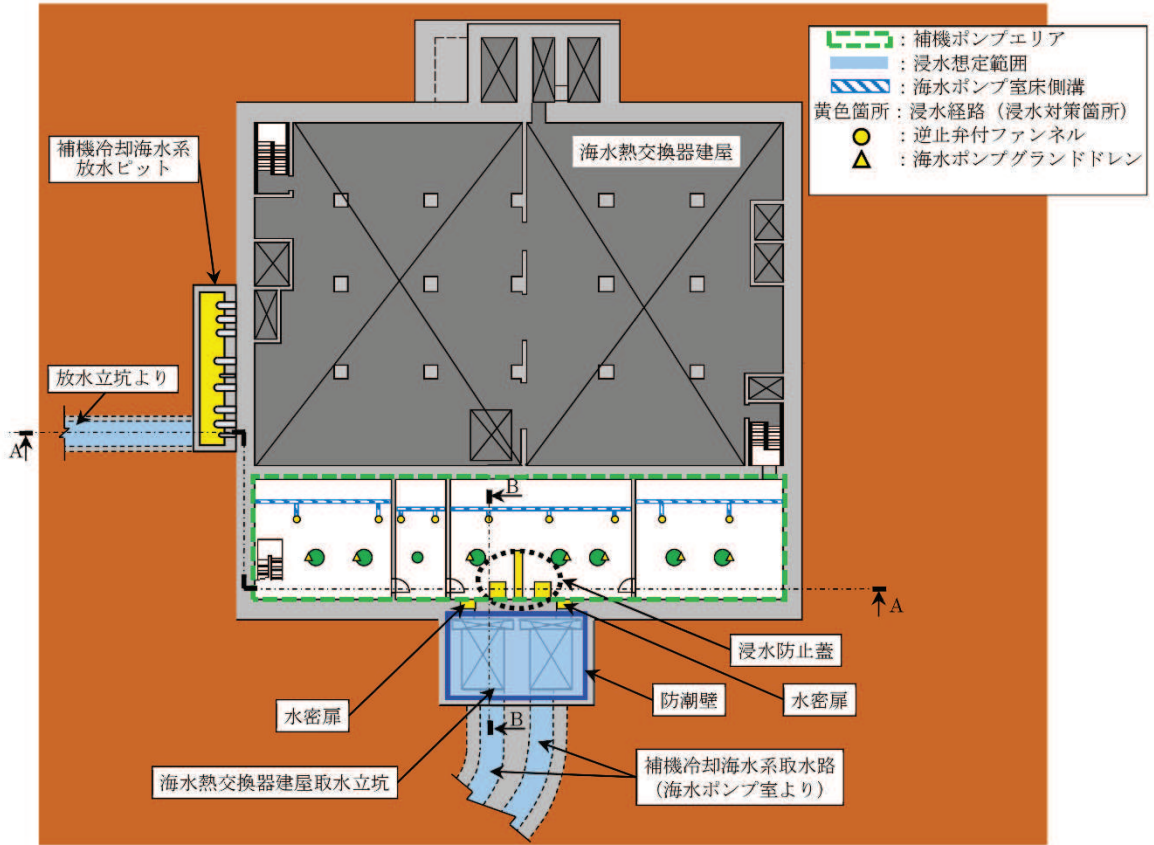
3号機 海水熱交換器建屋 浸水対策配置図 (平面図)
